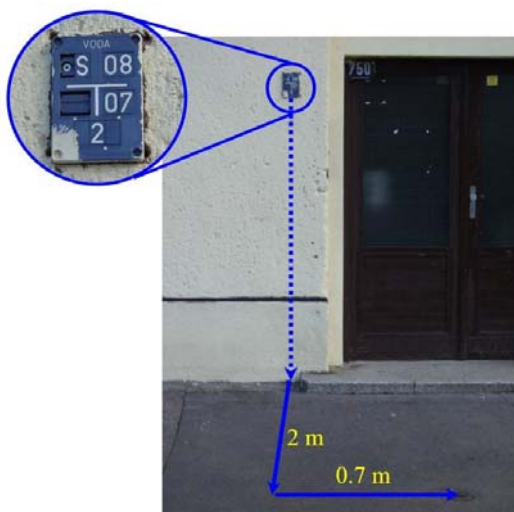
Diskrétní souřadnicový systém [208].
